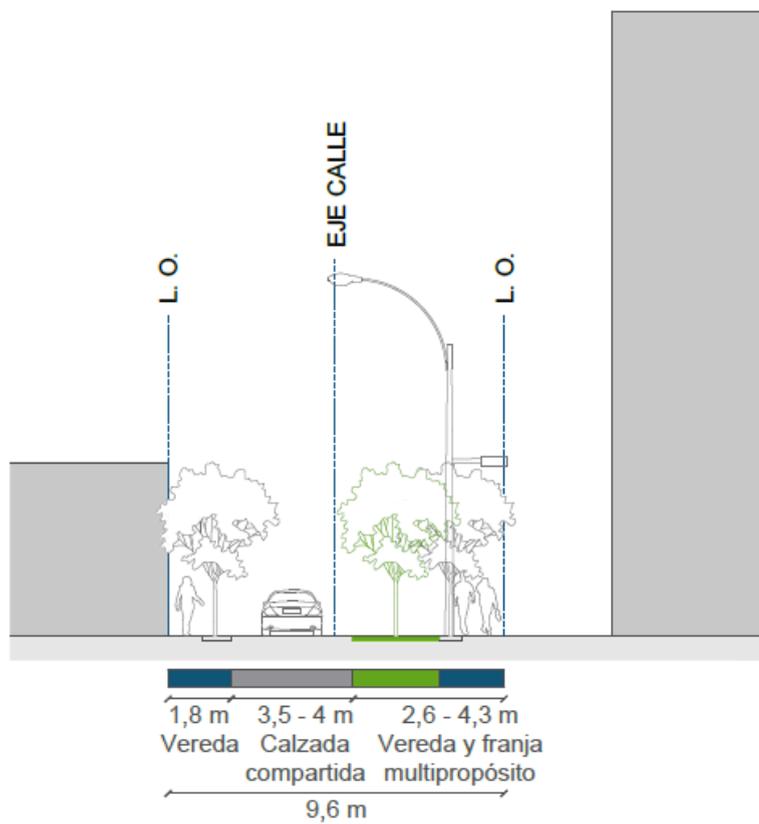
Perfil tipo. Situación propuesta calle Arzobispo Fuenzalida.
